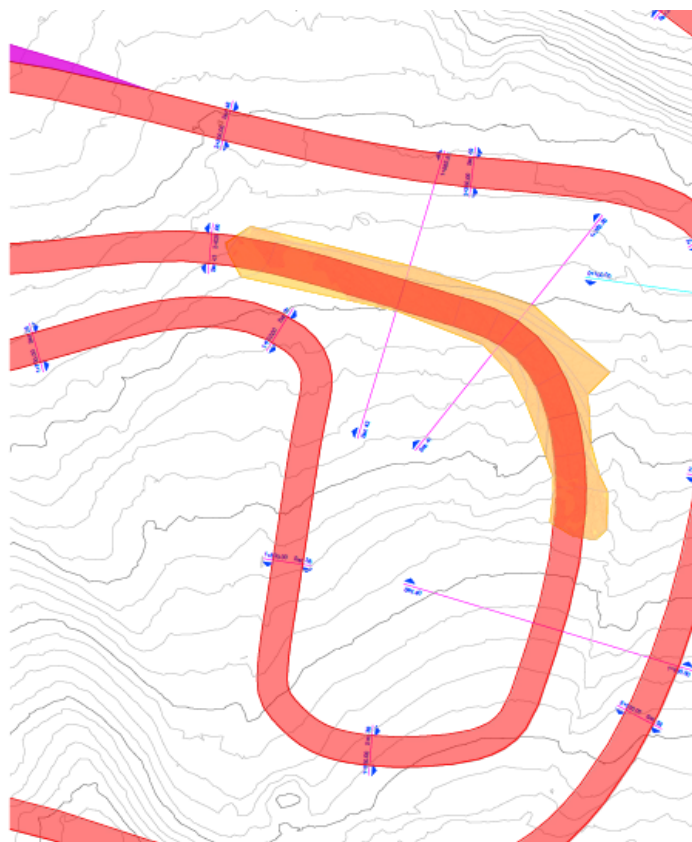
Estratto planimetria sterri e riporti - scala a vista
